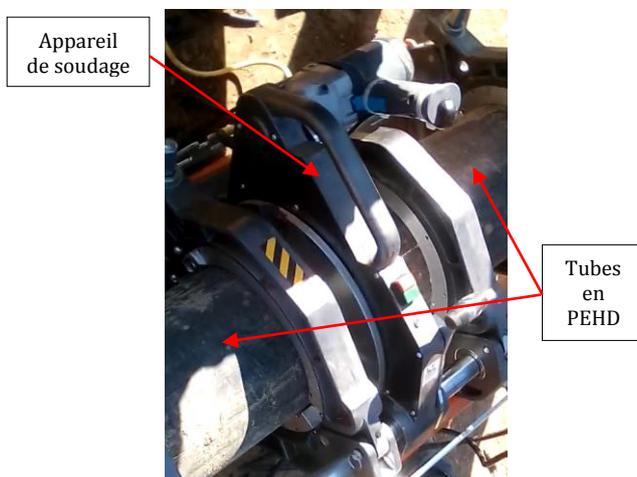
Préparation de l'opération de soudage bout à bout.
